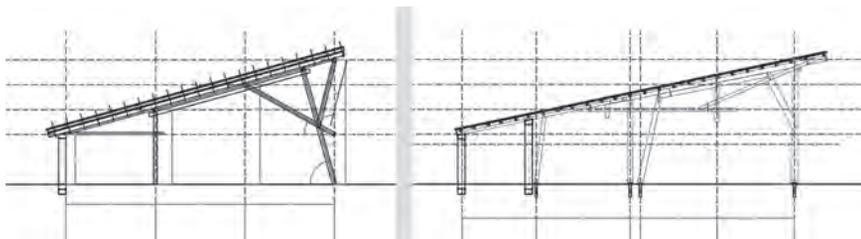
Dibujo lineal. Elaboración propia. Alzado de cercha propuesta por Miguel Ángel Odriozola (izquierda). Pórtico construido en 1947, posteriormente reconstruida en 2009 (derecha)
